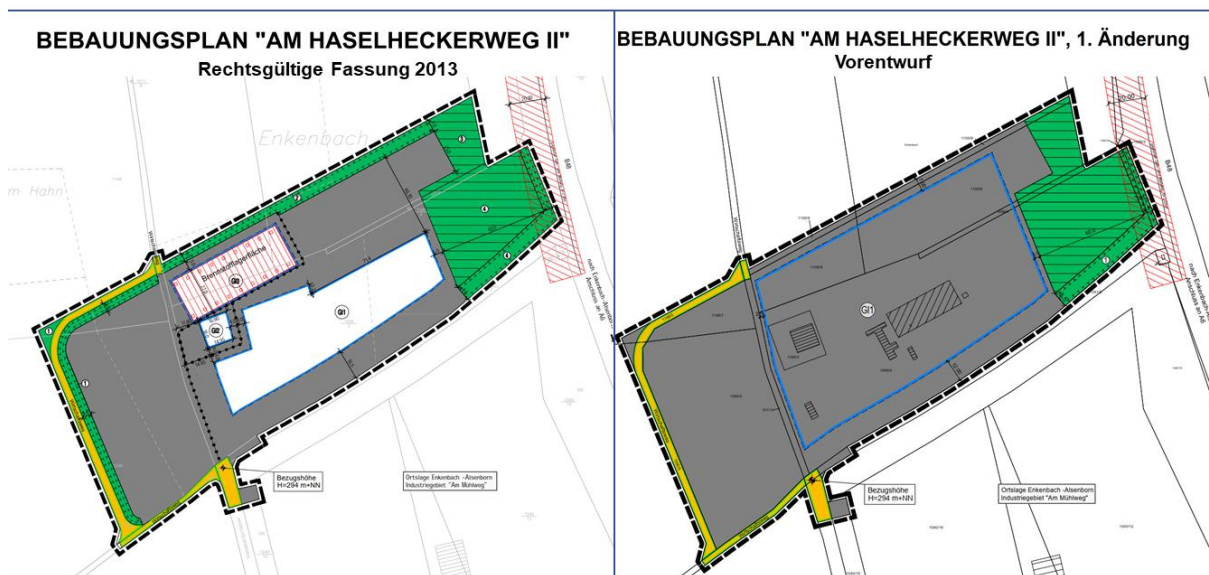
Gegenüberstellung Änderung des Bebauungsplans
